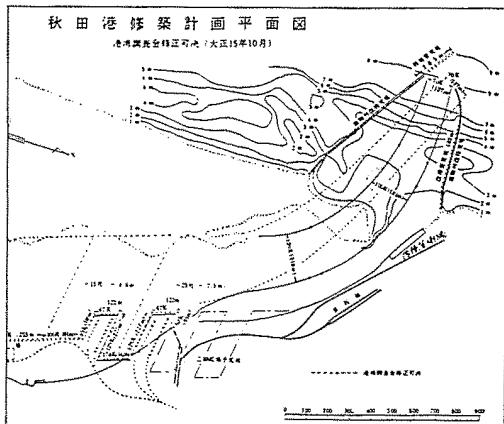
秋田港修築計画平面図（大正15年）⁴⁾
